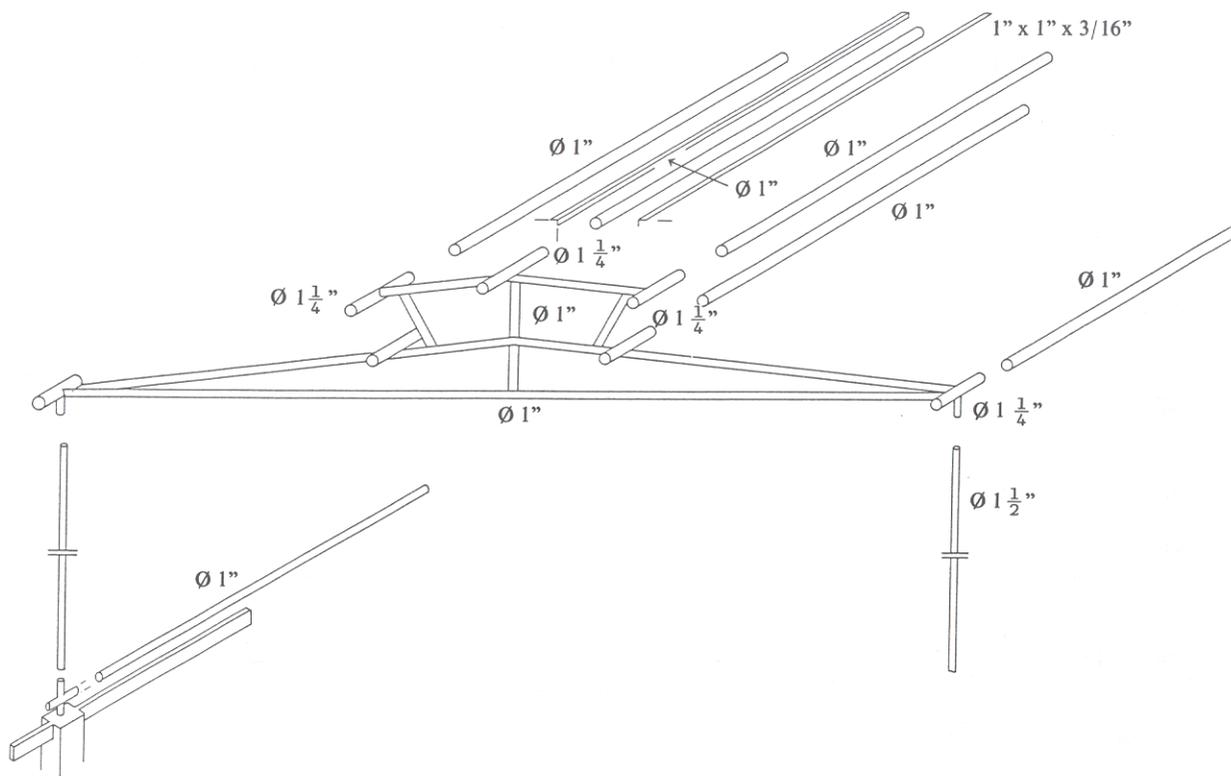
Plano de isometría para la colocación de la tubería en la casa de malla de tipo II; detalles constructivos. Diseño: D. R. Laing y R. J. Segovia. Julio 1988.
